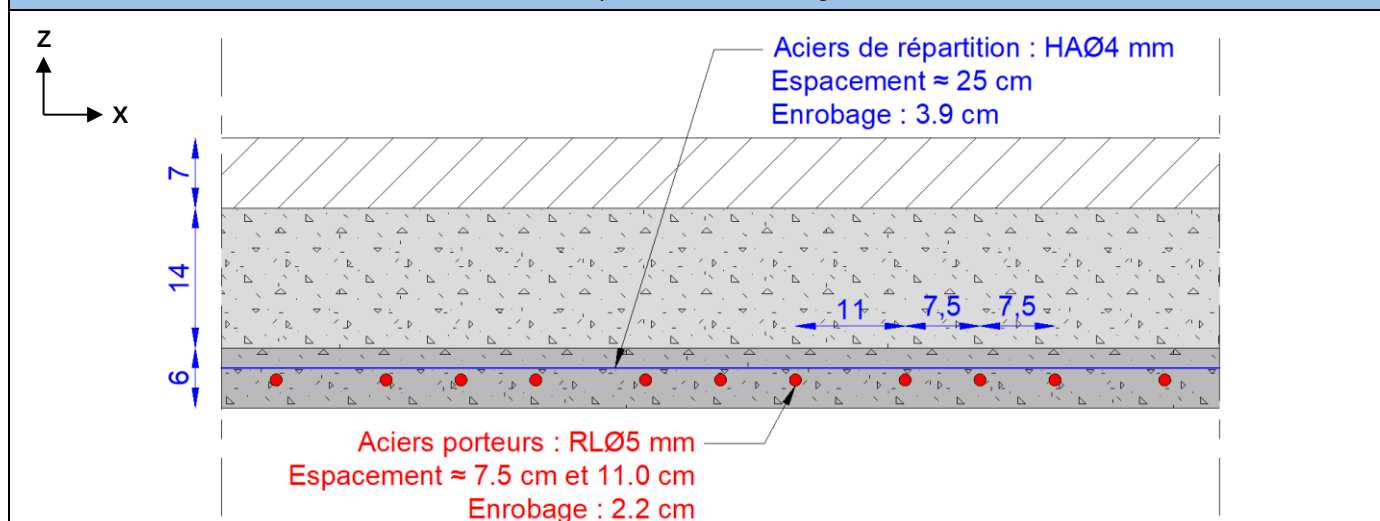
Coupe transversale à mi-travée du sondage SD1
